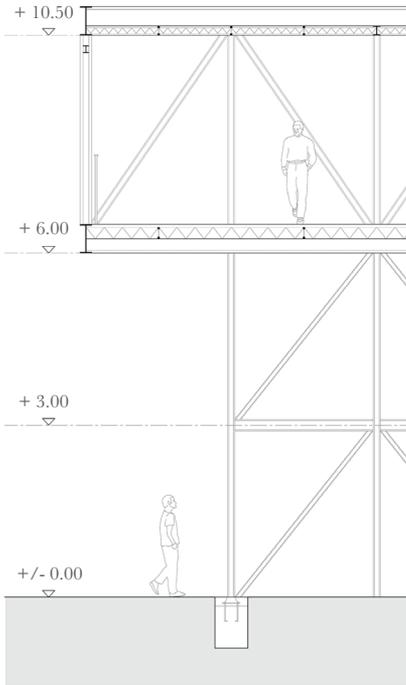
Estructura tipo steel joist para cubrir grandes luces de cubierta.
